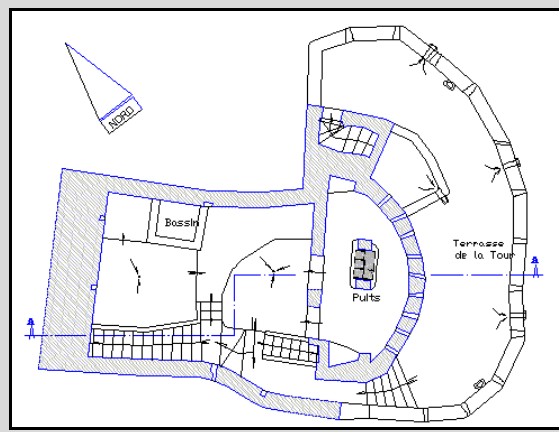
Ouvrage hydraulique de la vallée du M'zab
